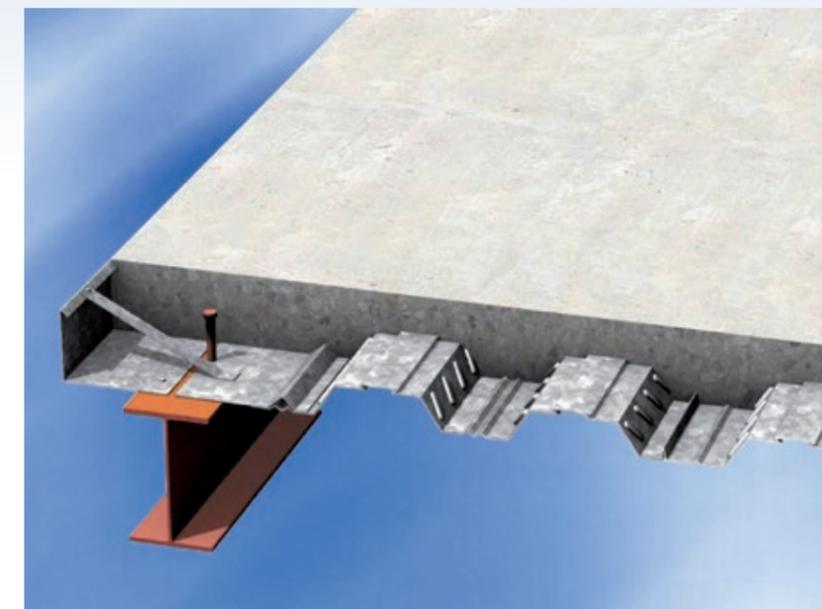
Композитная сталежелезобетонная плита и композитная стальная контурная балка Kingspan
